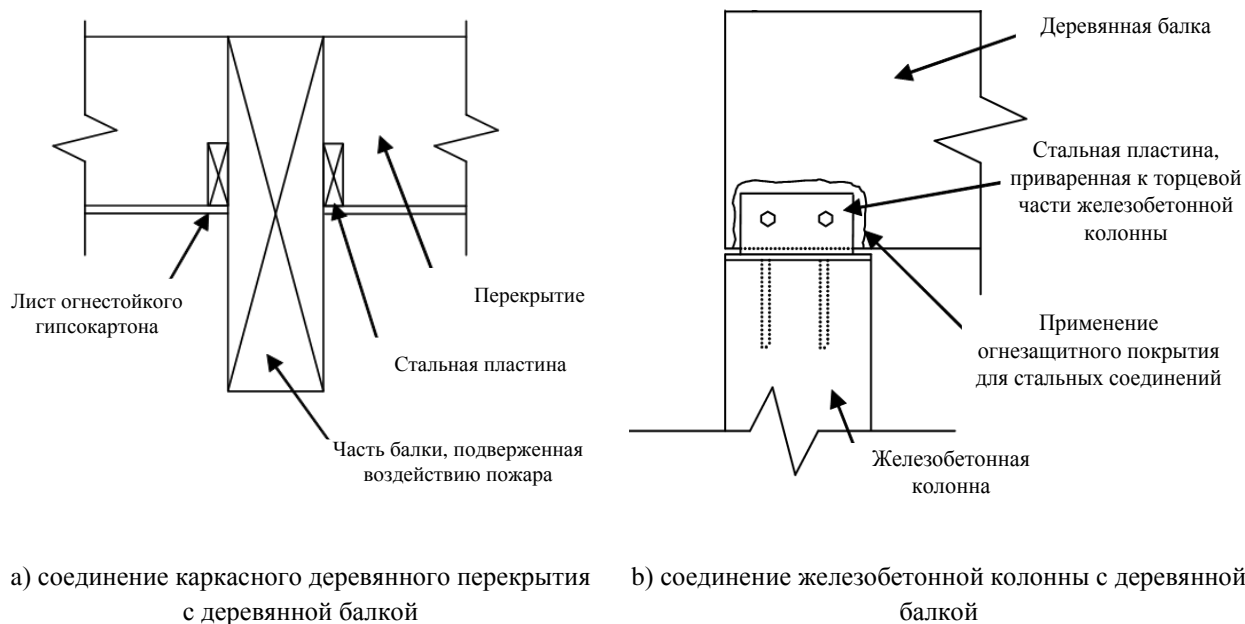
Пример соединения деревянной балки с каркасным перекрытием и железобетонной колонной
